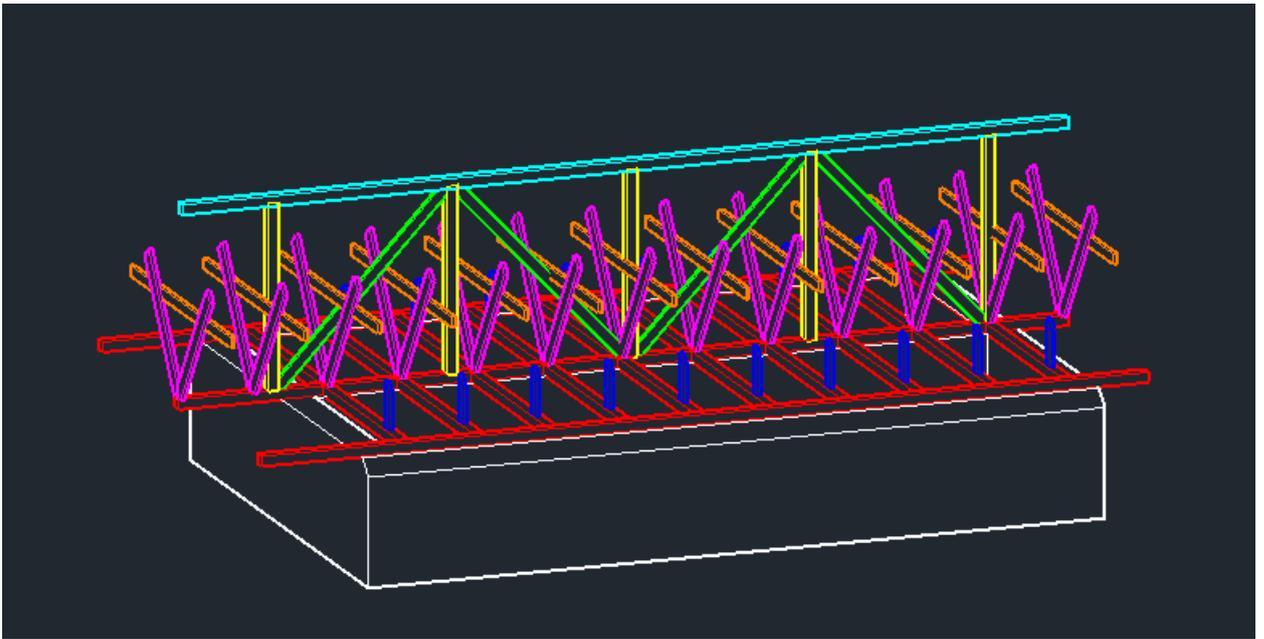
Создание затяжек и опорных стоек для стропильных ног
